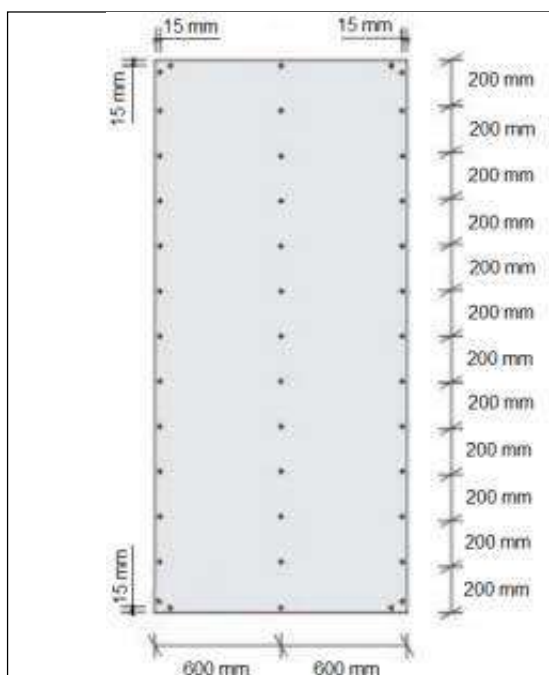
Detalle del espaciado entre tornillos de fijación de placas cementicias.
